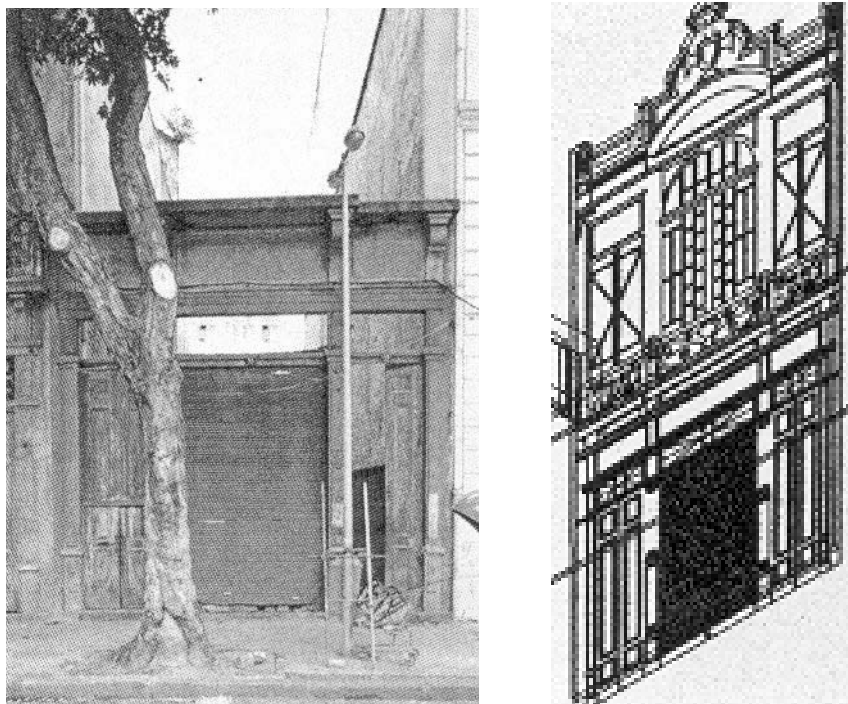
Fachada remanescente da edificação à praça Tiradentes, 71 e projeto para a nova fachada (SECRETARIA, 2000, p. 60 e 61).
